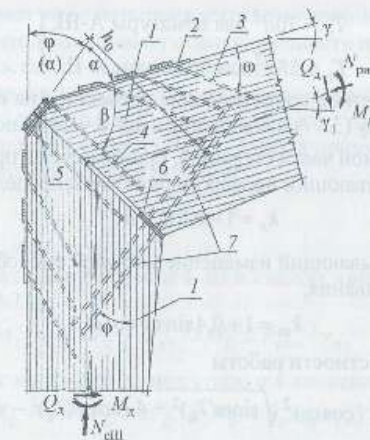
Расчетная схема карнизного узла рамы на вклеенных стержнях: 1 – клеёные блоки ригеля и стойки; 2 – накладка из полосовой стали; 3 – арматурные стержни, вклеенные под углом ω ; 4 – стержни, вклеенные под углом β ; 5 – стык накладки 2 в случае выполнения рамного узла монтажным; 6 – пластина клеештыревых шайб; 7 – штыри, вклеенные под углом ω к волокнам
